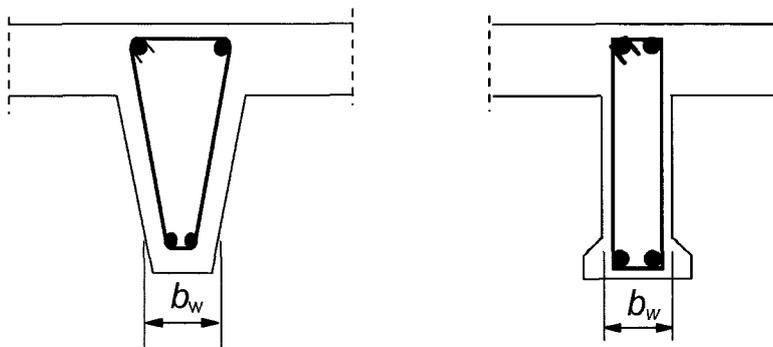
Fachwerkmodell und Formelzeichen für Bauteile mit Querkraftbewehrung
